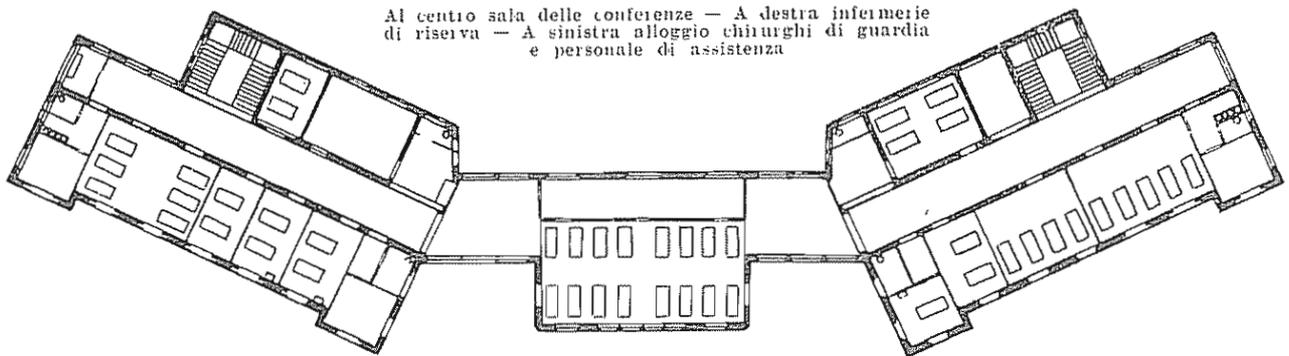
PADIGLIONE ACCETTAZIONE E GUARDIA — PIANTA DEL PRIMO PIANO
